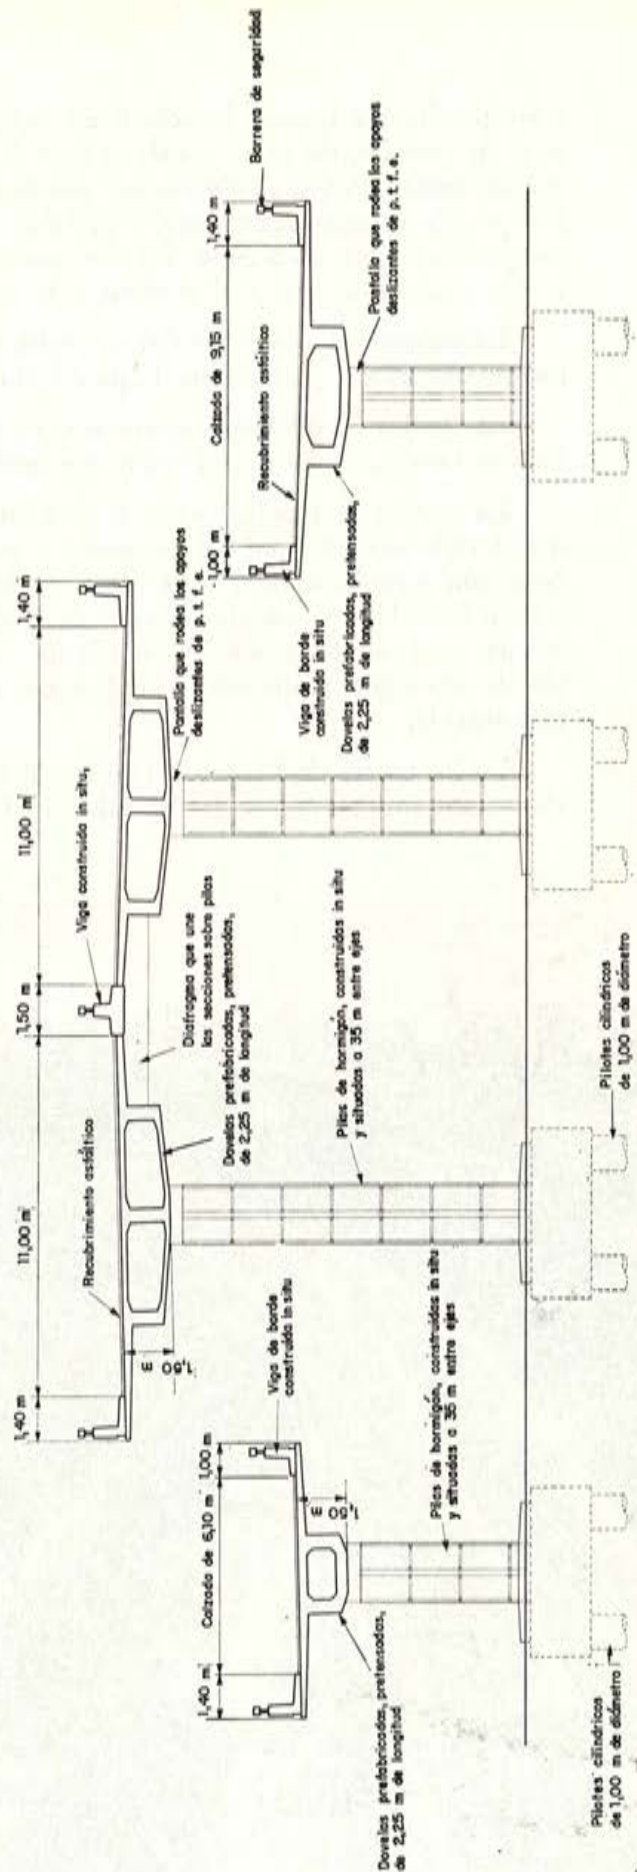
Paso elevado de Westway, en Londres. Sección transversal de las estructuras de un tramo de dos calzadas de tres carriles y de los tramos de acceso en rampa.
